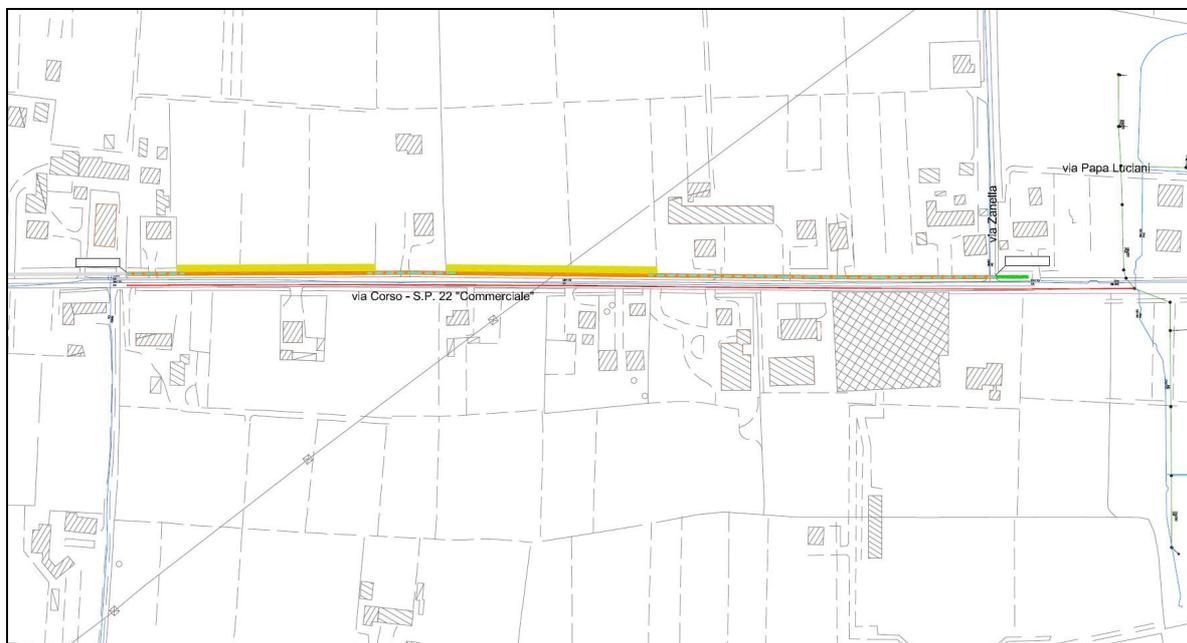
ubicazione delle zone interessate dagli interventi di progetto su C.T.R
